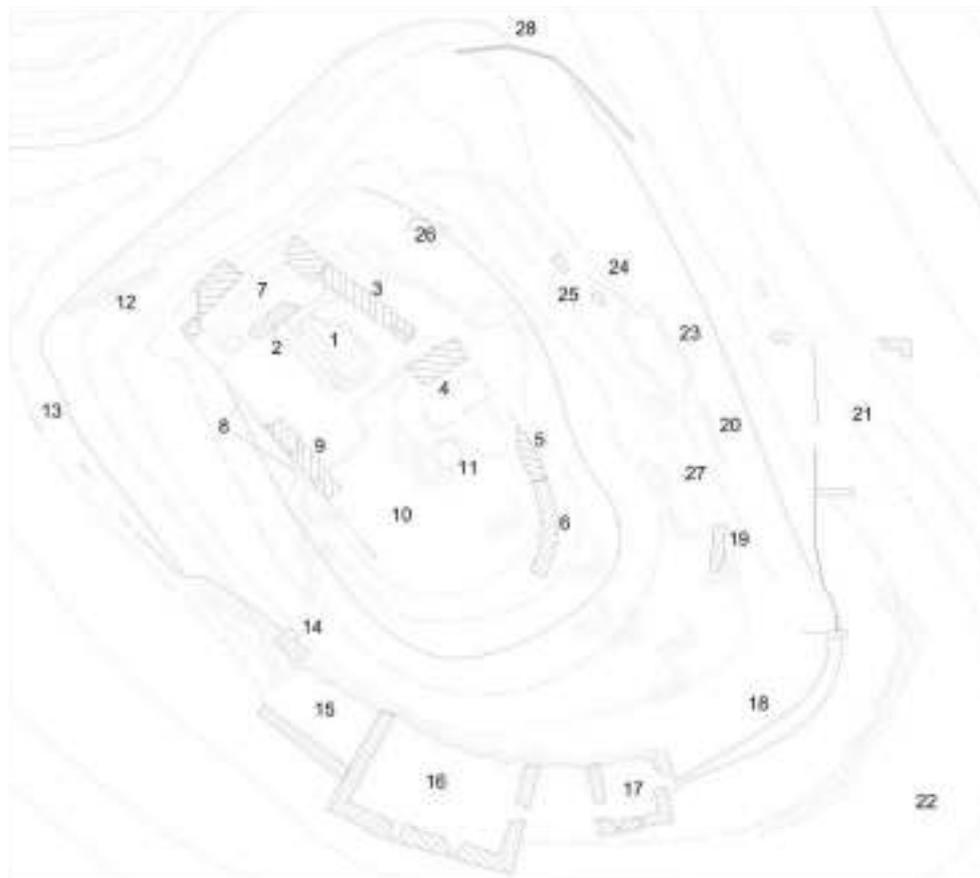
Burg Waldeck, Grundrissplan der Gesamtanlage mit Befundkennziffern, Vermessung: ARRATA e.V., Zeichnung: A. Schmidt
